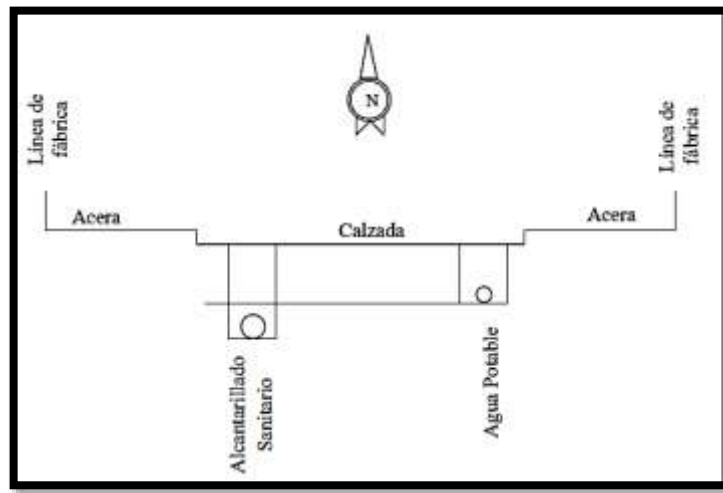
Ubicación de la Red de Sistema de Alcantarillado
